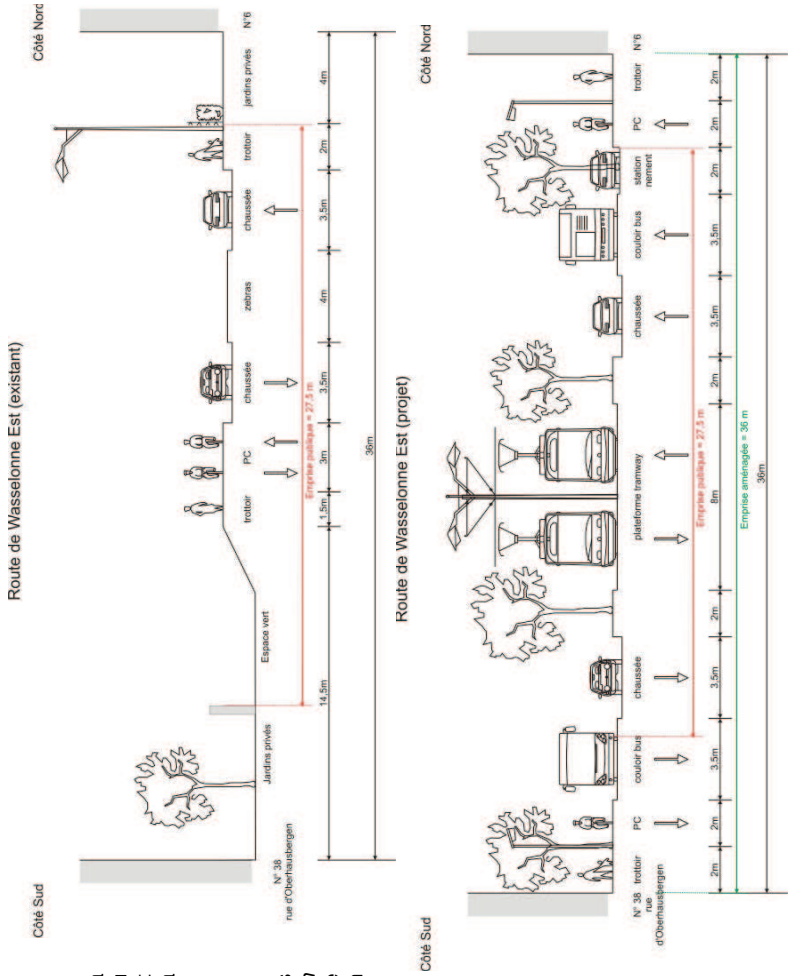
Situation existante : coupe sur la route de Wasselonne
